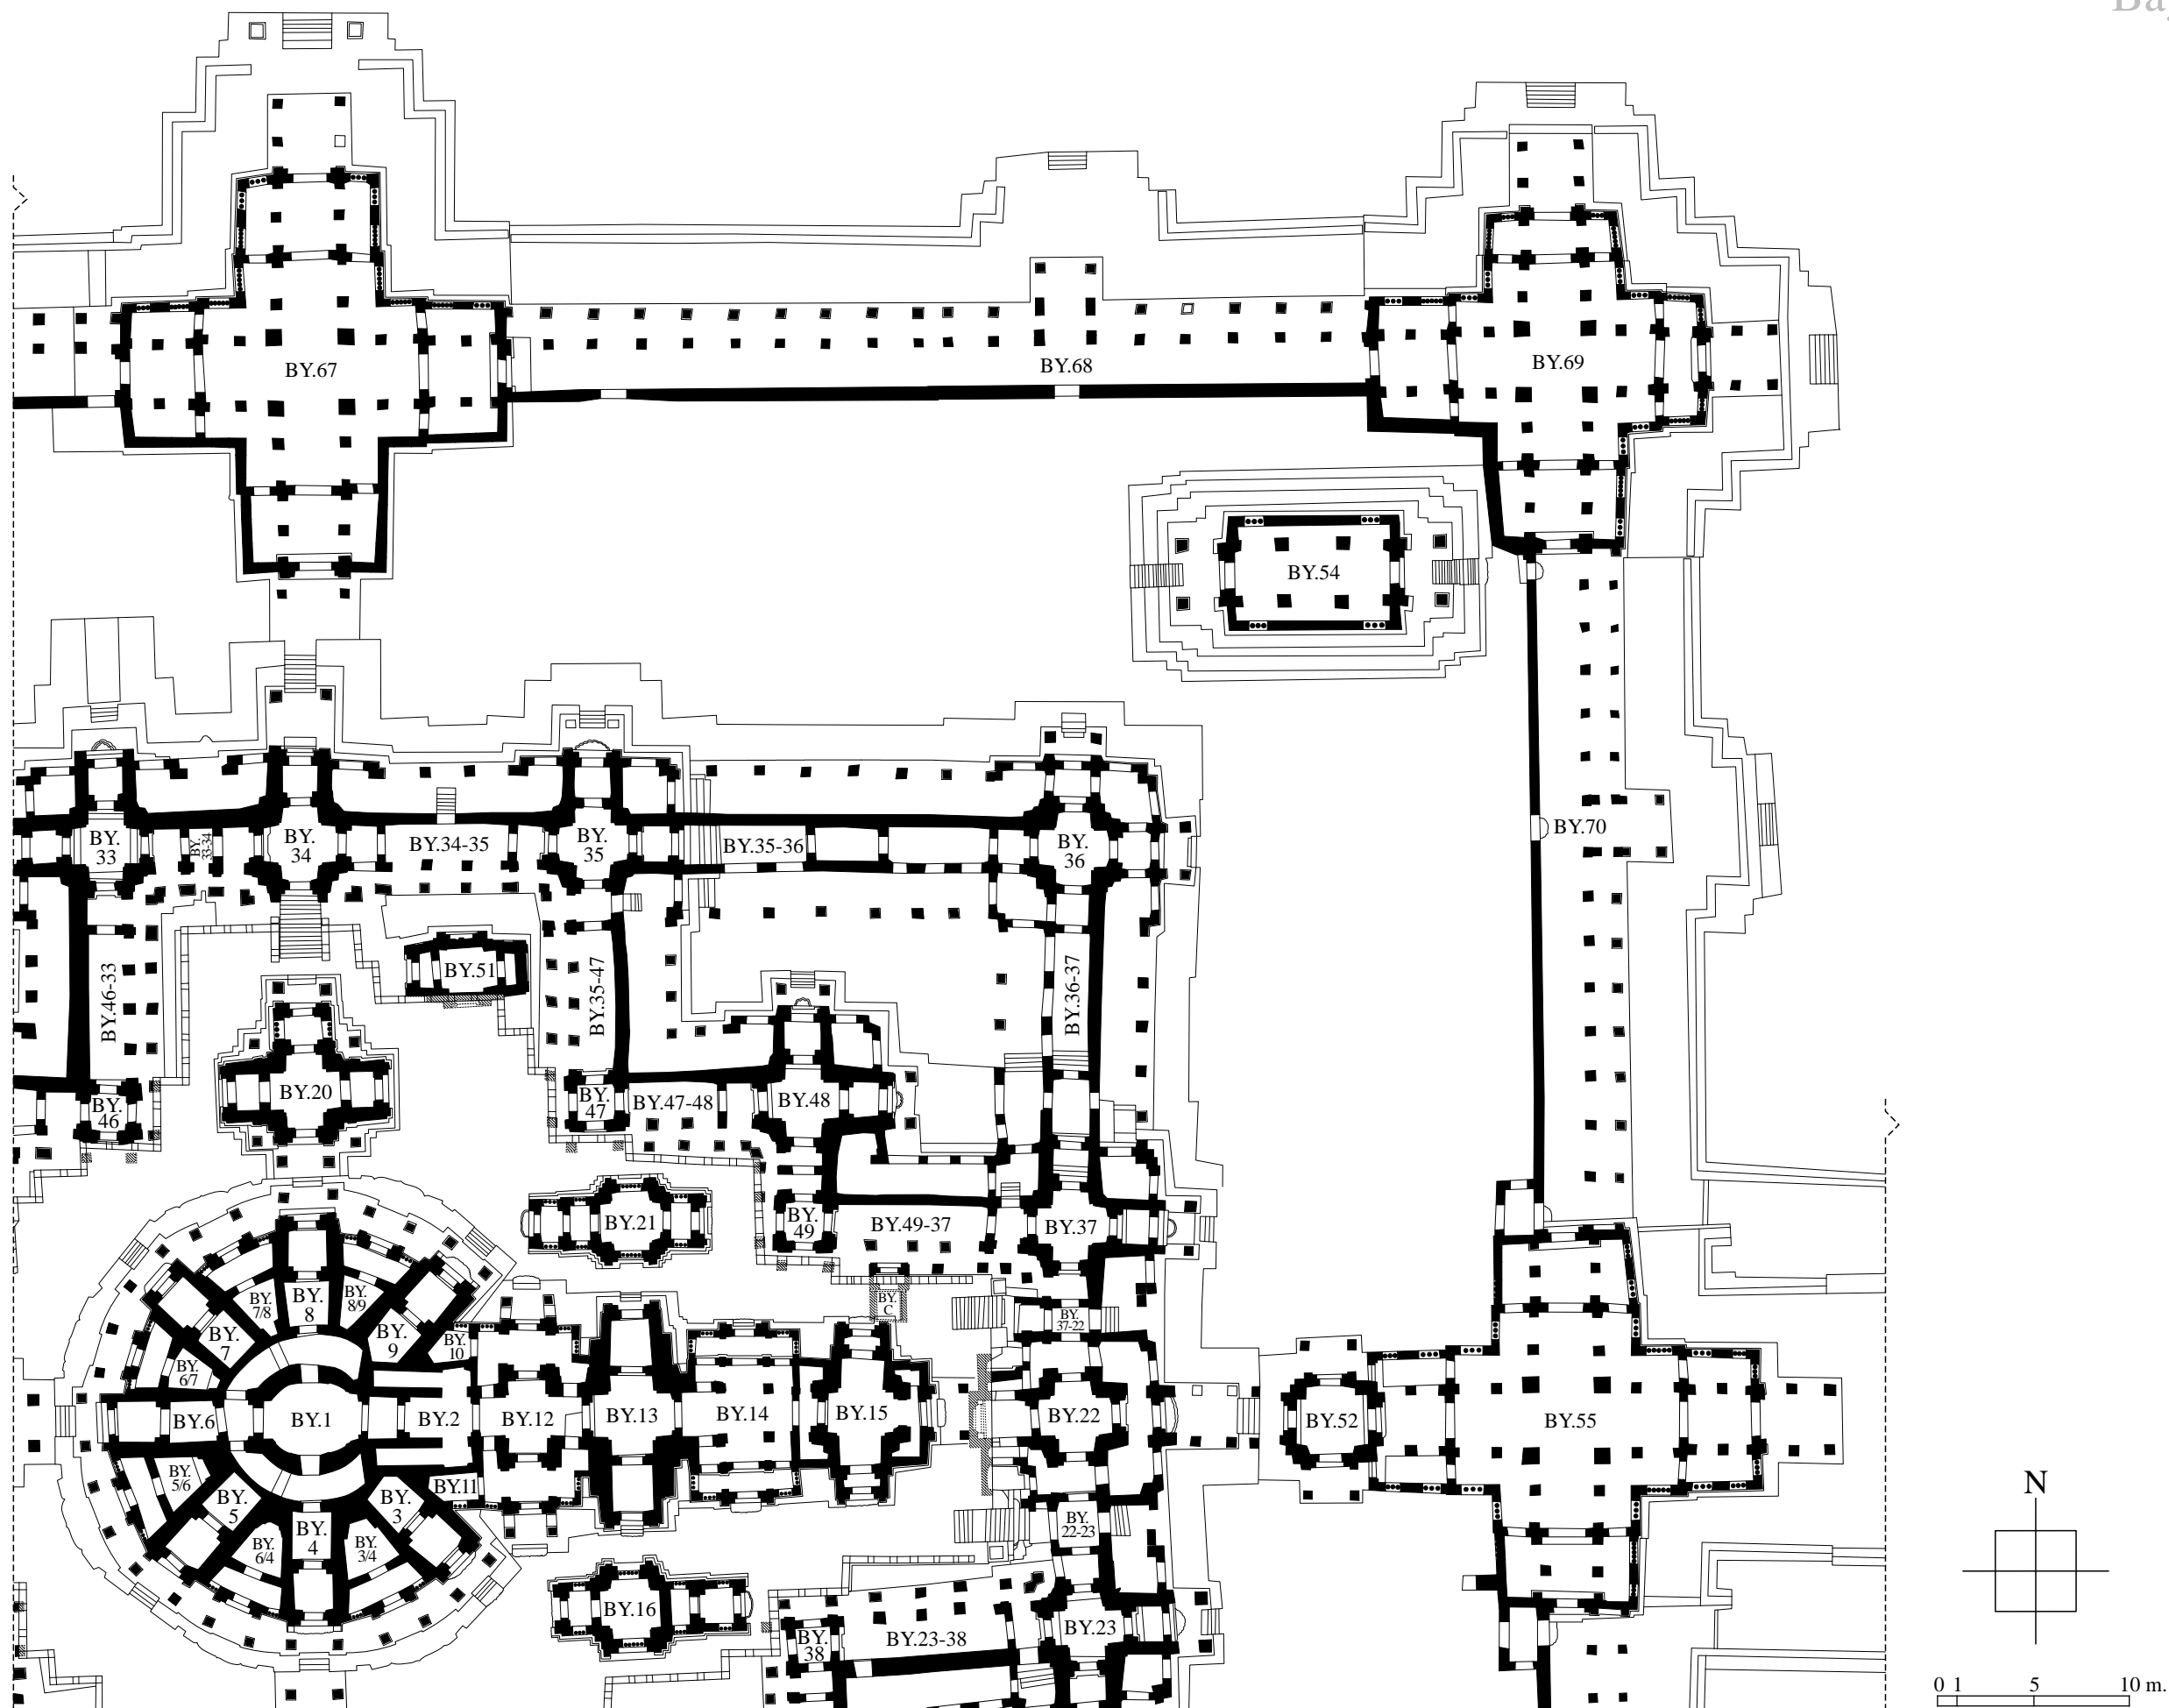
Plan du quart Nord-Est du Bayon
